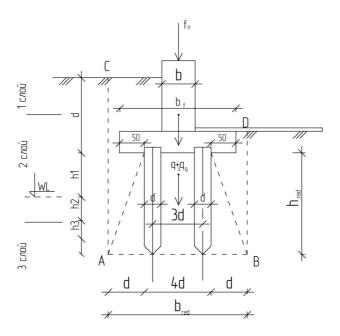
Схема определения границ условного фундамента при расчете осадок свайных фундаментов
